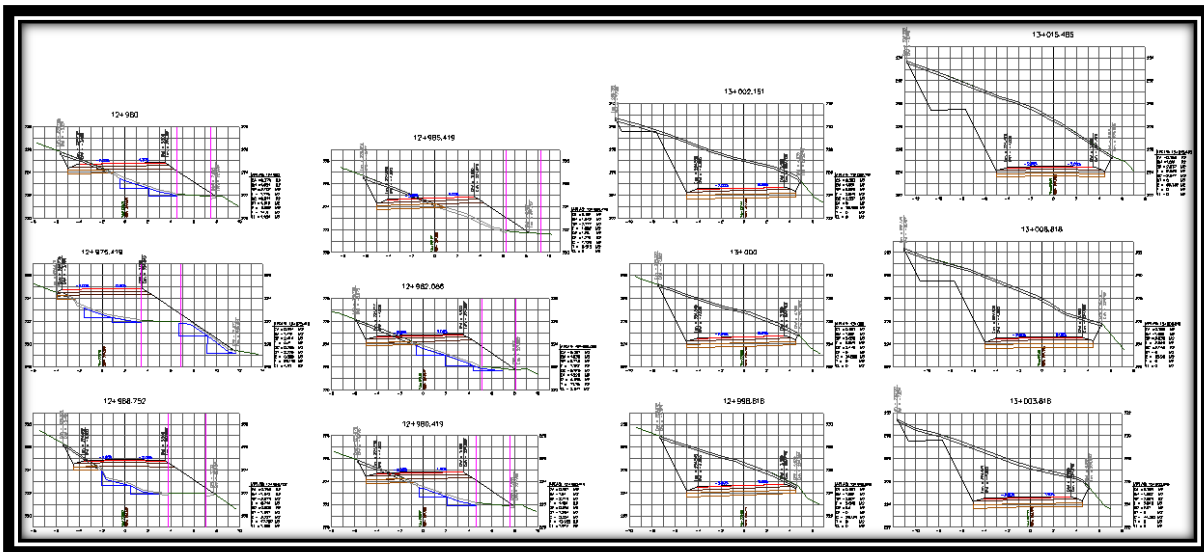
Secciones de construcción del km 12+968.752 al km 13+015.485.
